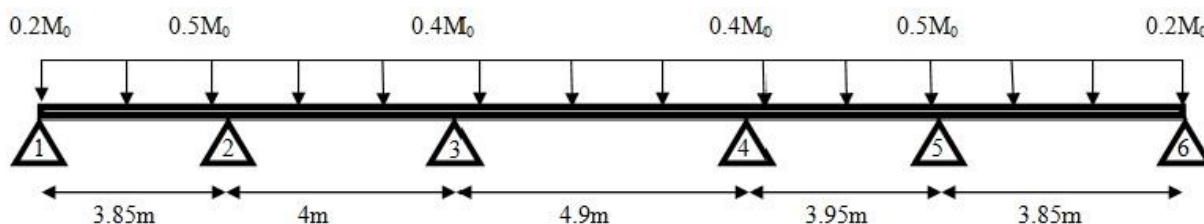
Schéma statique de poutrelle (1<sup>er</sup> type étage).
